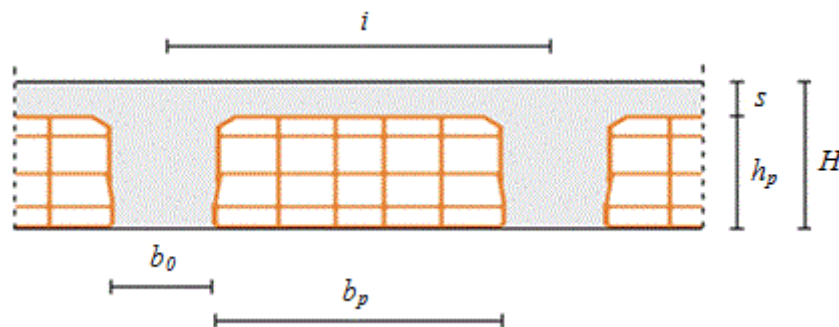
Sezione trasversale del solaio latero-cementizio.
